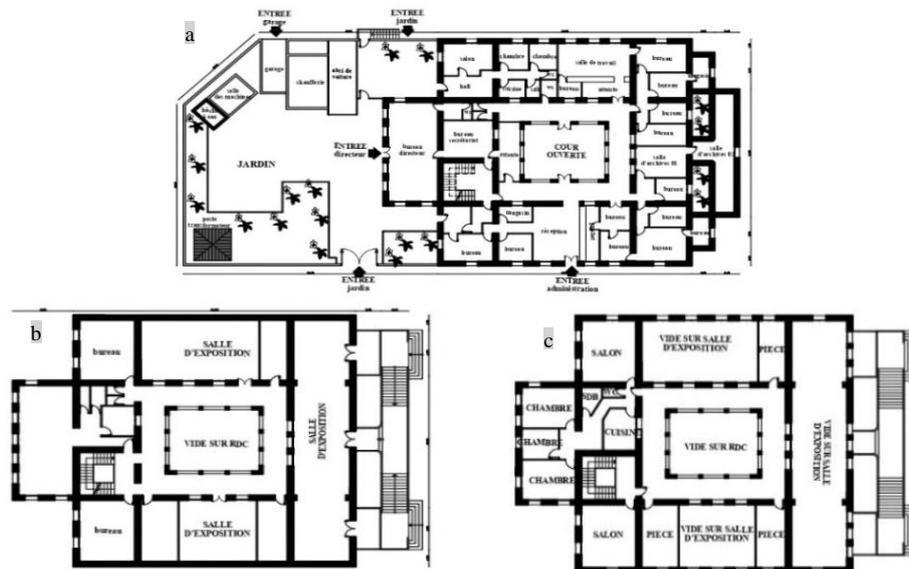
Relevé architectural du musée. (a) Plan du RDC, (b) Plan du R+1, (c) Plan du R+2 (Dessins rétablis par l'auteure à partir des plans consultés aux Archives de la direction d'el Moudjahidin, 2023)
